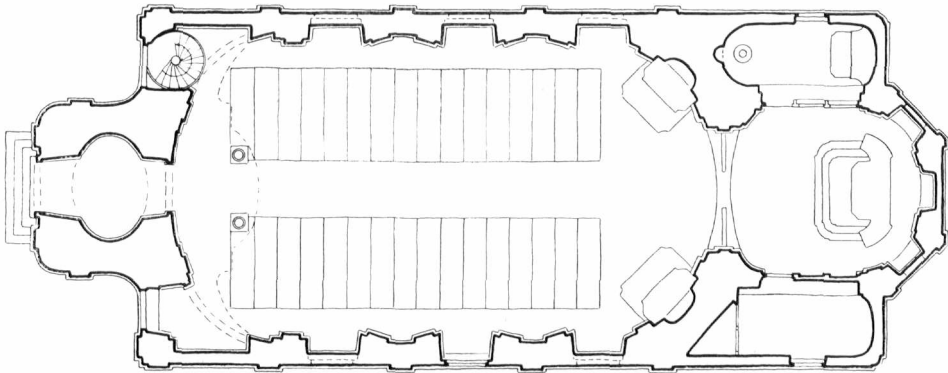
Radungen. Katholische Kirche. Grundriß 1:300
